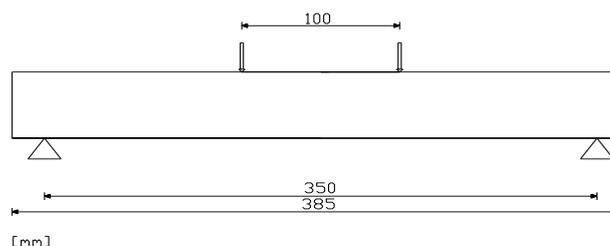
Planta do 1º ensaio à flexão e distancias entre os apoios.
